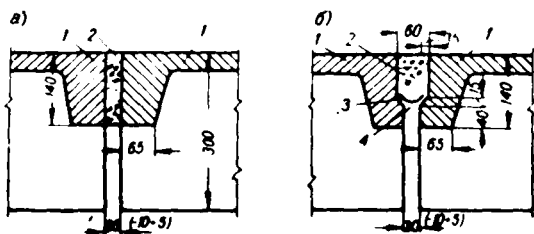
Поперечный шов между плитами длиной 6 м по чертежам плит типовых серий (а) и по усовершенствованному решению (б)
